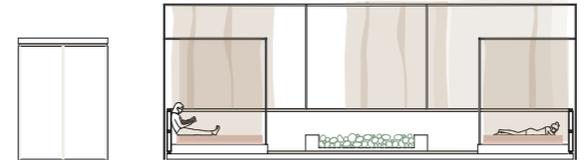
Entspannung: Grundriss und Schnitt
